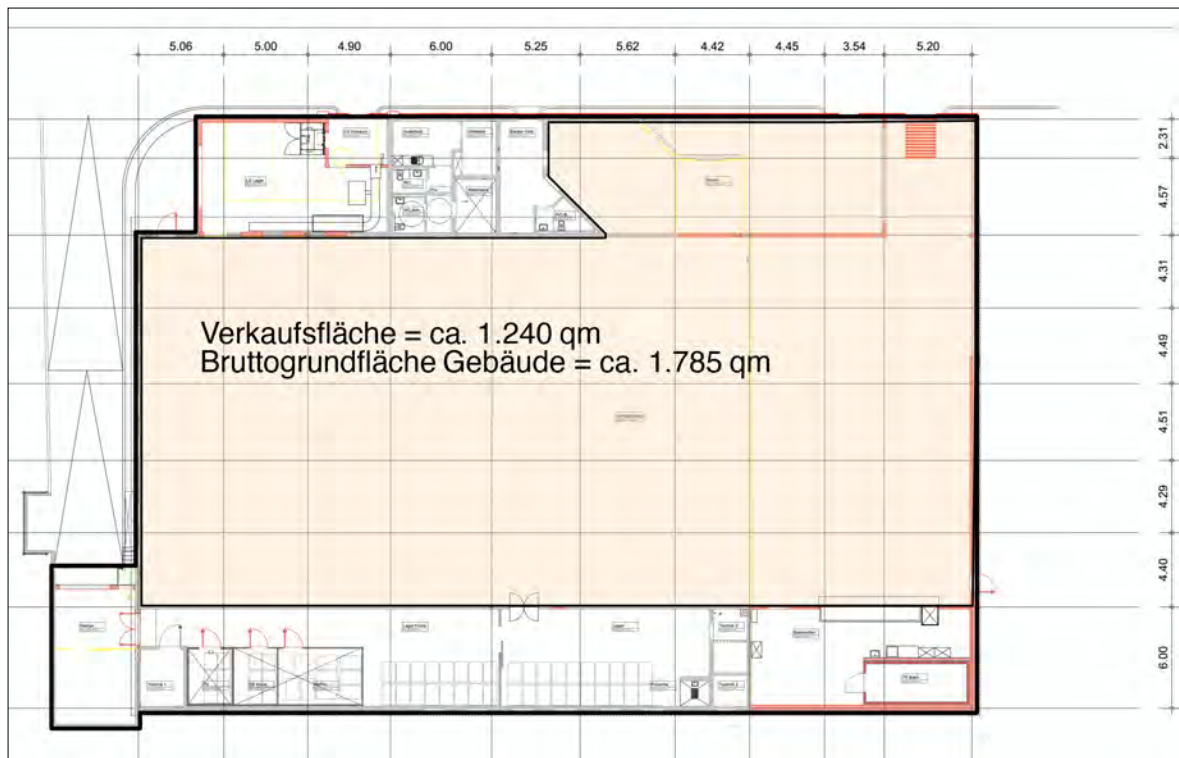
Grundriss Nahversorgungsmarkt (Quelle: Architekturbüro Krauter+Kling, Berlin)
